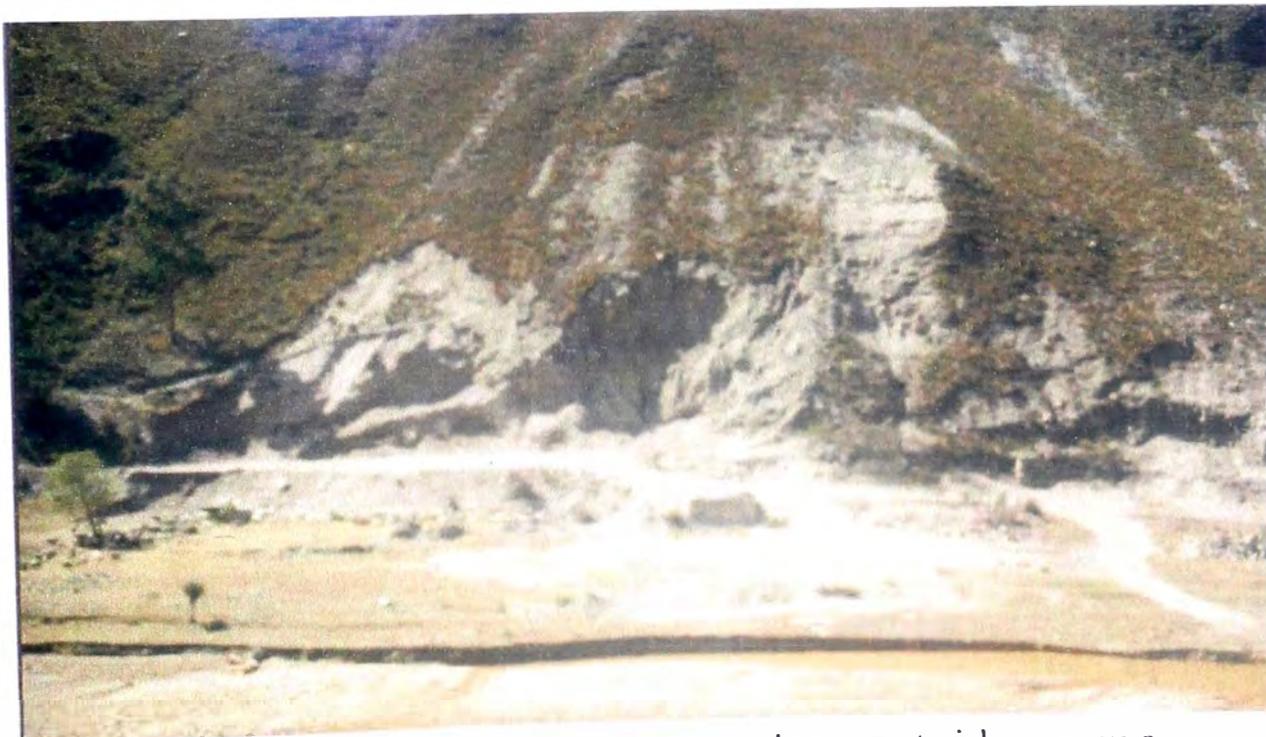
Se aprecia la ubicación de canteras para obtener material que se va a utilizar en la conformación de la estructura del pavimento.
